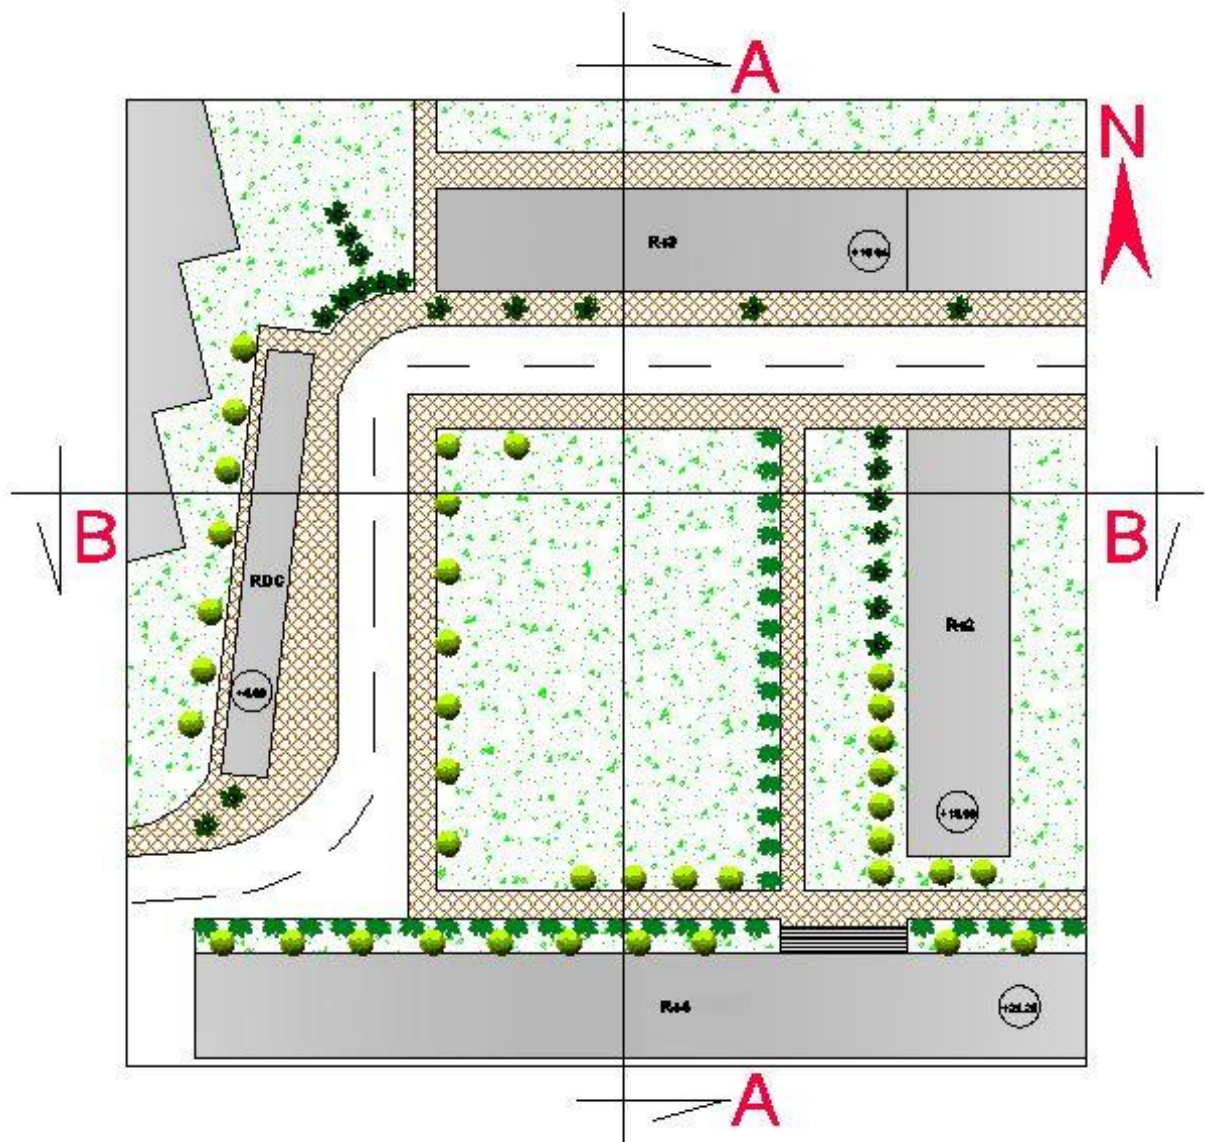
Choix des coupes sur le plan de la place de la cité Les Bananiers, dessiné sur Autodesk-Autocad.
